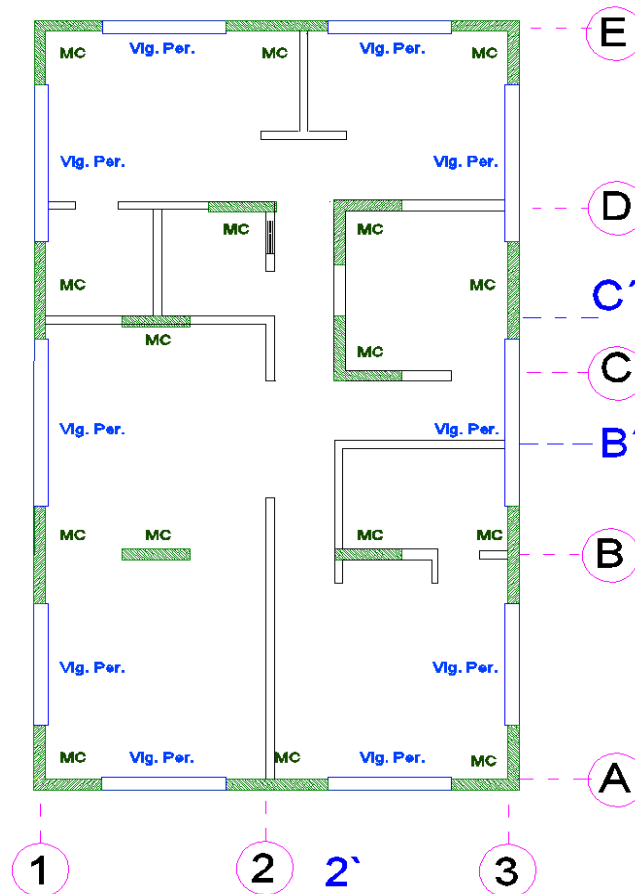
ESTRUCTURACIÓN – SISTEMA MUROS DE CORTE, LOSAS PLANAS
